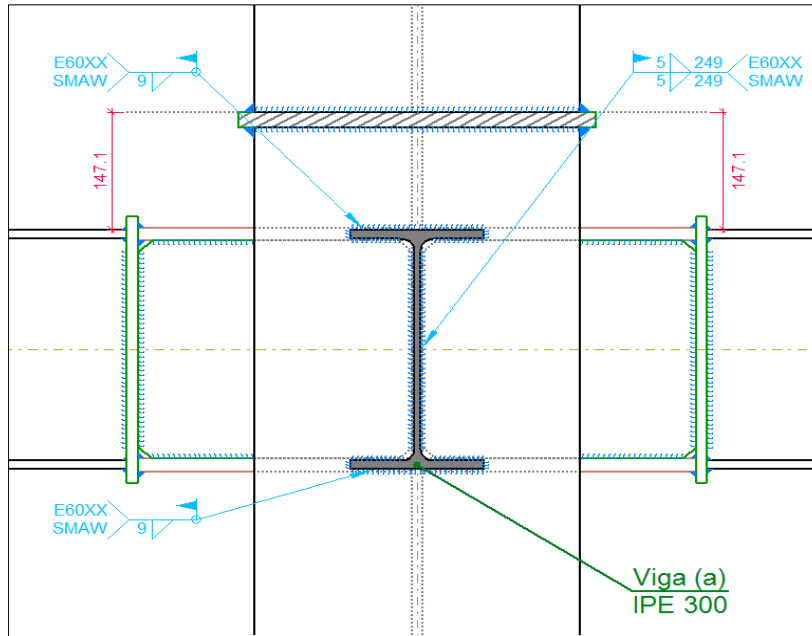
Tamaño de las soldaduras para la Viga IPE.
